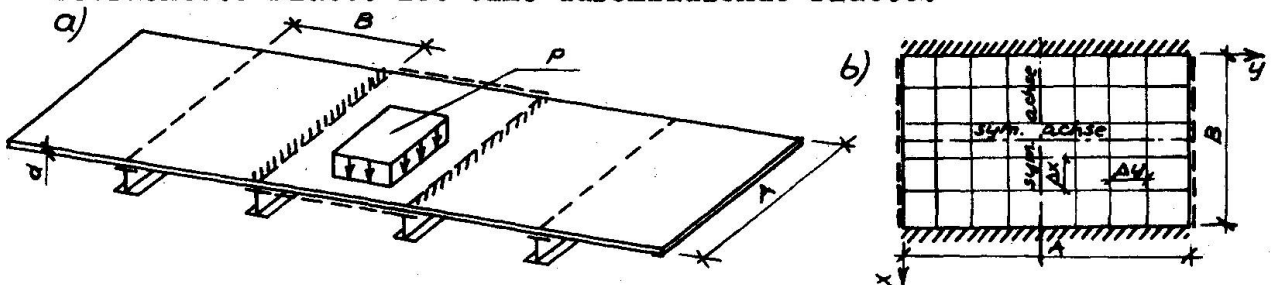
Stahlträgerverbunddecke. a) Ansicht, b) Schema der Auflagerung der Betonplatte und eine Gitterverteilung zur numerischen Berechnung
